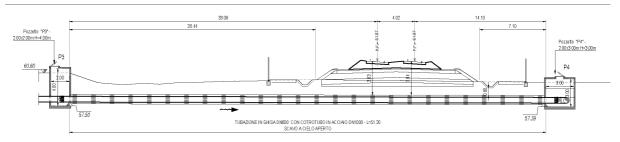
Attraversamento pk 15+013,920 - Sezione Trasversale
